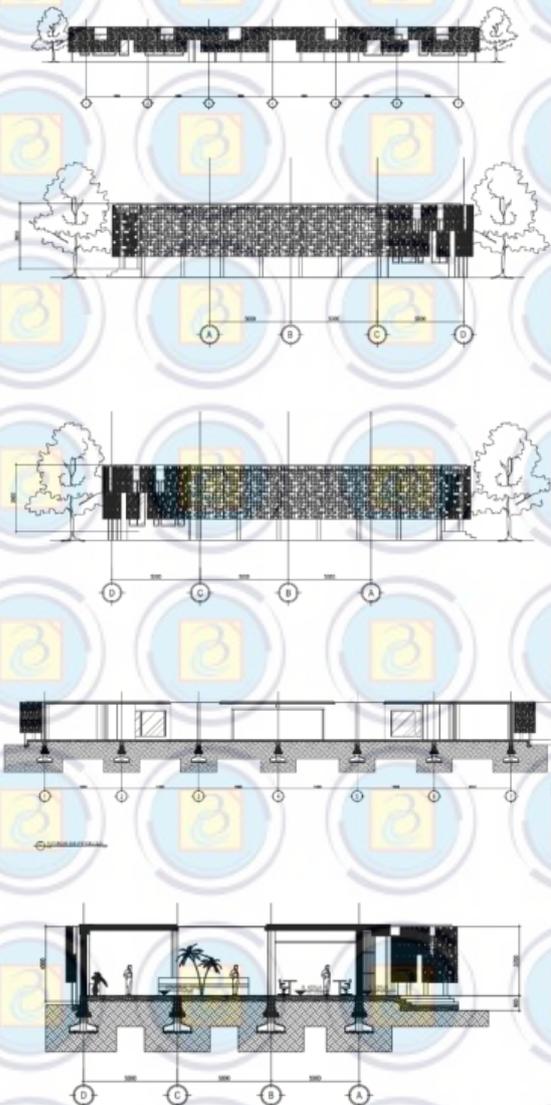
5 denah, tampak dan potongan Gedung galeri
